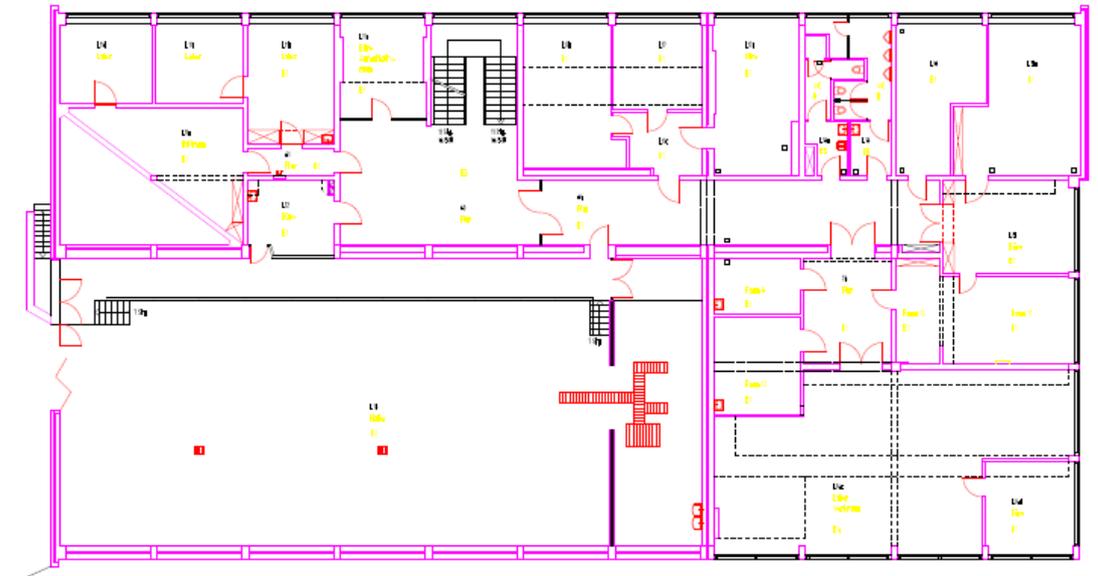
Grundrissplan 1. OG, Gebäude HF
